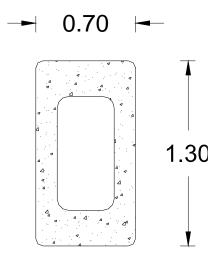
Viga de hormigón armado tipo. Nota. Ingeniero Civil Oscar Milton
